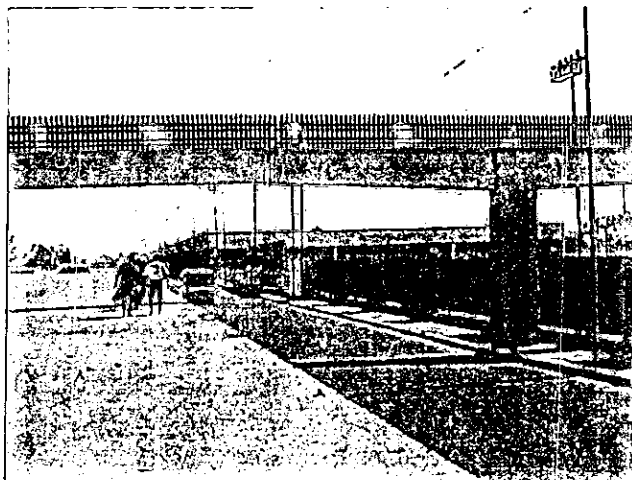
Se observa la articulación, lado derecho viga portante, lado izquierdo viga sección constante
